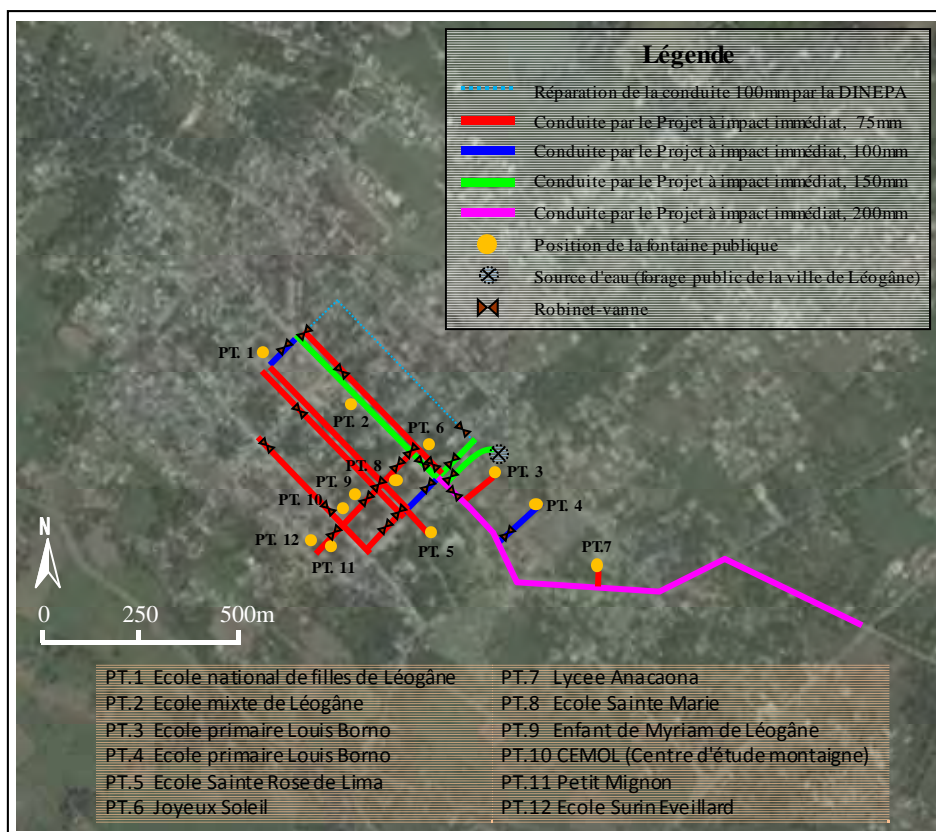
Plan de disposition des installations hydrauliques de la ville de Léogâne
